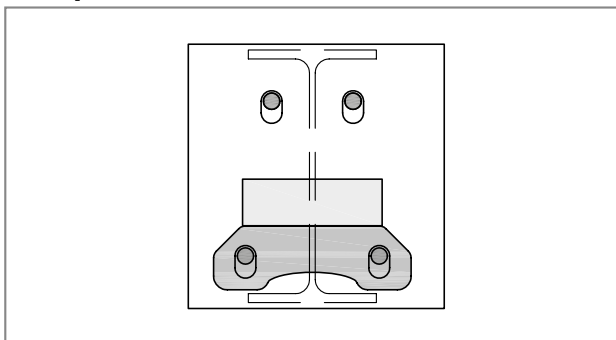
Schöck Isokorb®: raccordo acciaio – calcestruzzo armato; il dente a taglio in opera poggia direttamente sulla piastra a compressione
